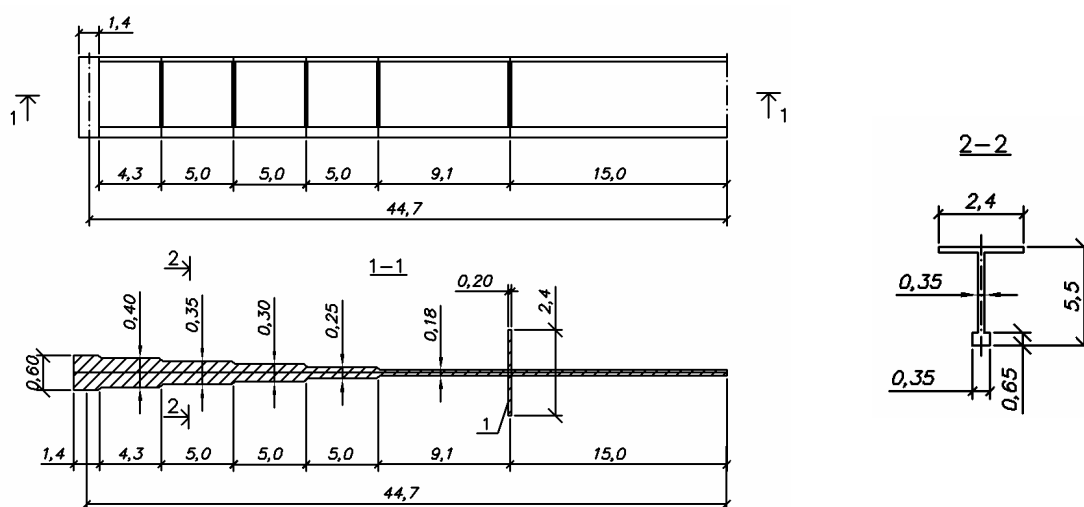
Железобетонная балка покрытия ангара в аэропорту Дюссельдорф (размеры в м): 1 – ребро жесткости
